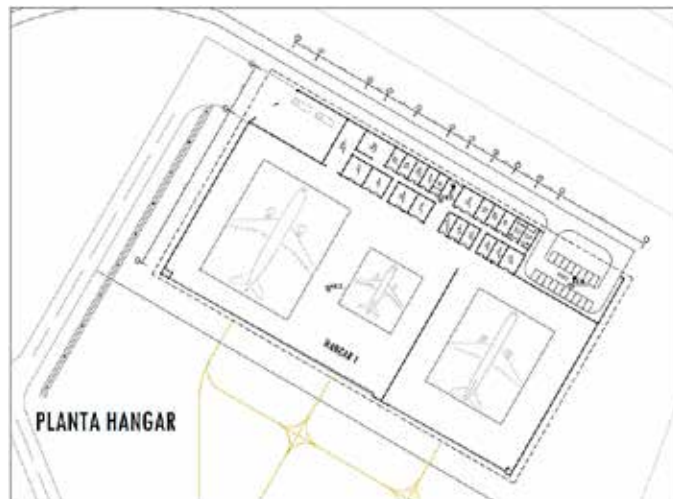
Planta baja edificación hangar. Fuente: Sosa (2020)
